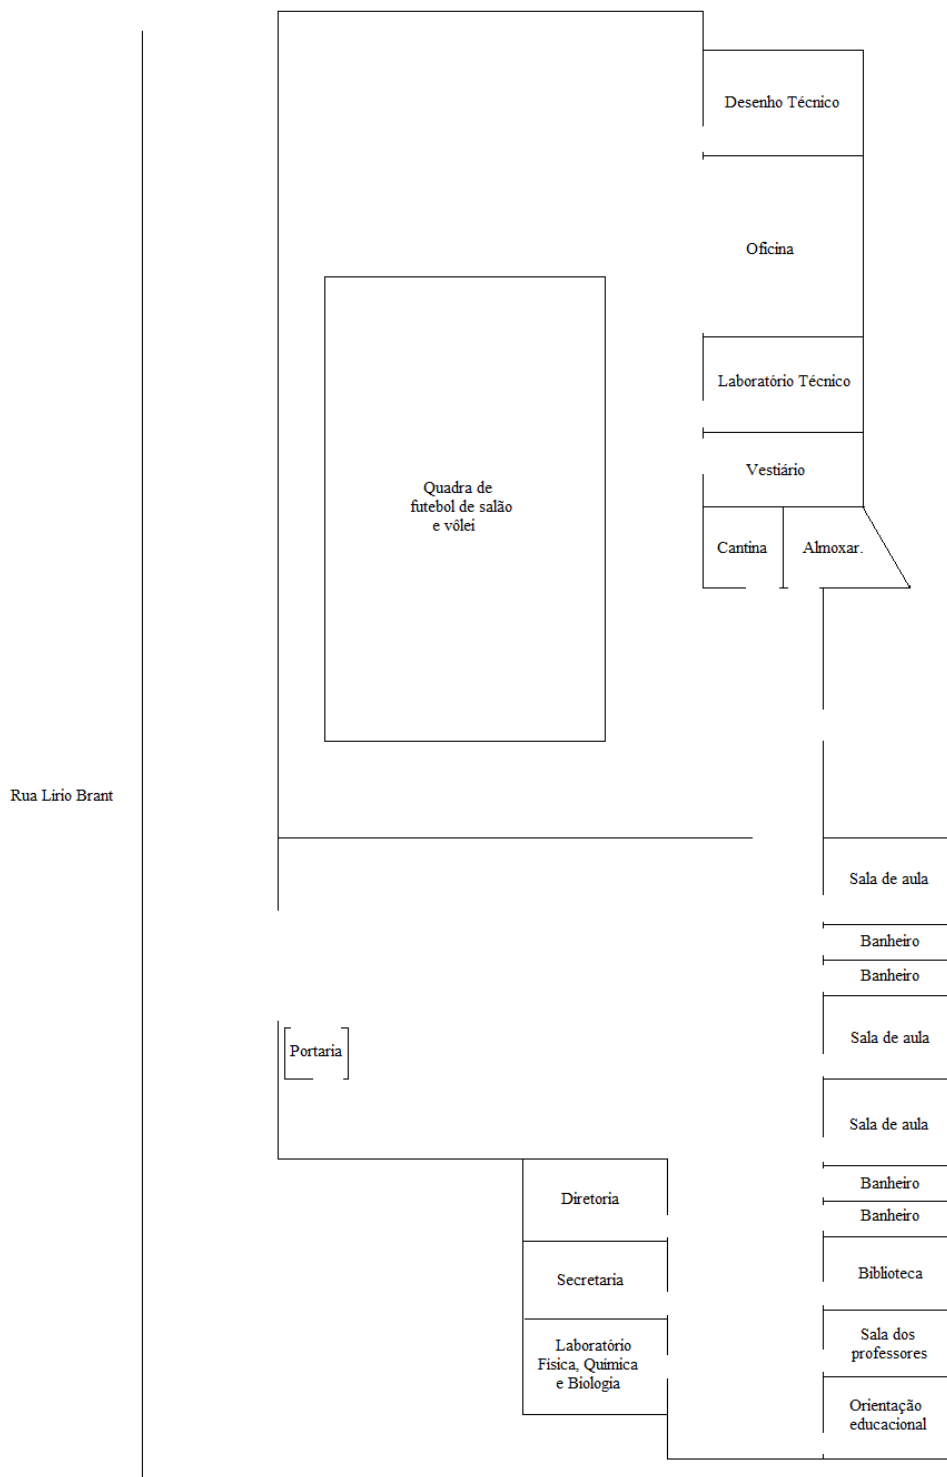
Planta baixa simplificada das primeiras instalações da Escola Técnica
